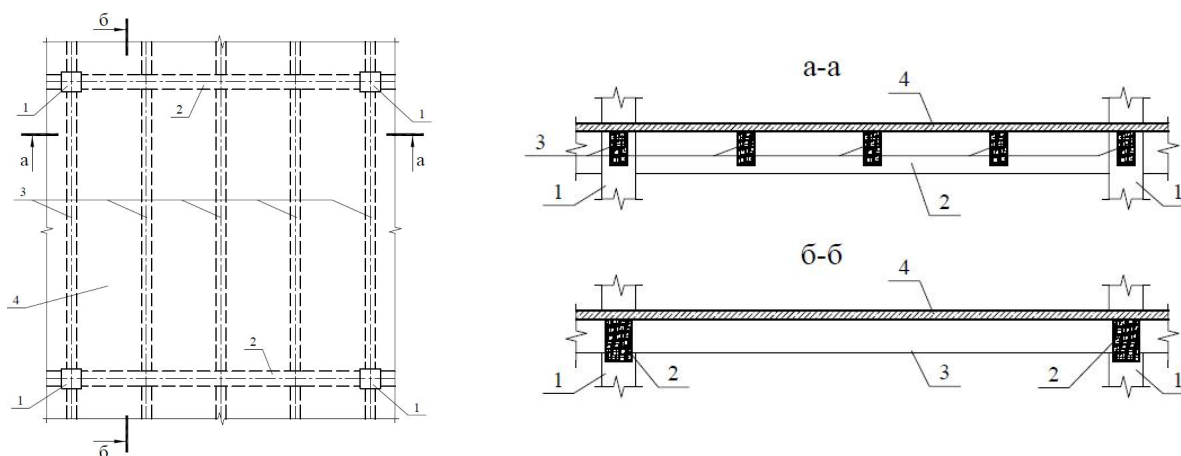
Схема гібридного деревозалізобетонного перекриття: 1 – колони; 2 – головні балки; 3 – другорядні балки; 4 – залізобетонна або армувана ґрунтобетонна плита
